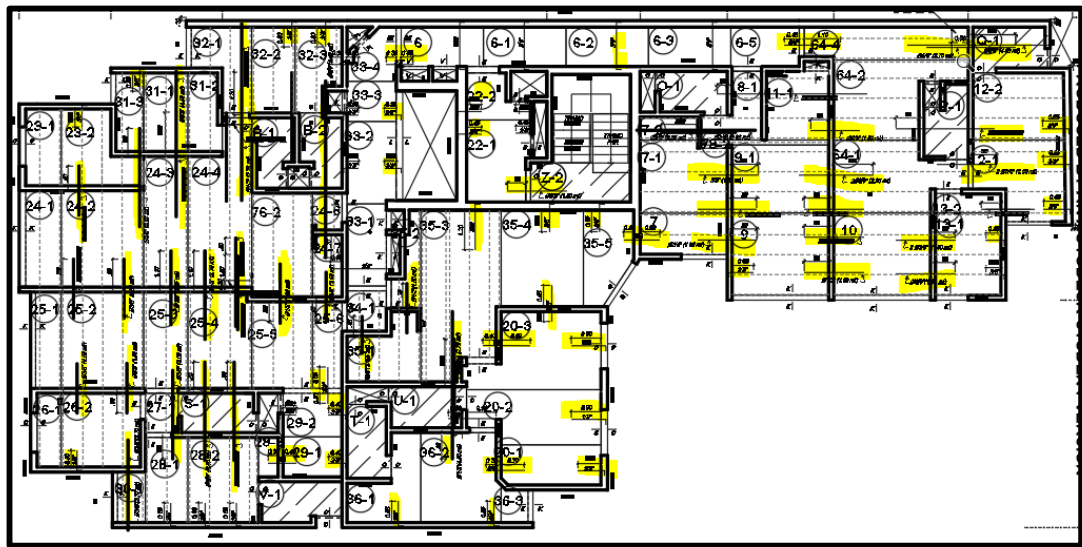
Plano Distribución de acero Negativo - Sistema Prelosas
